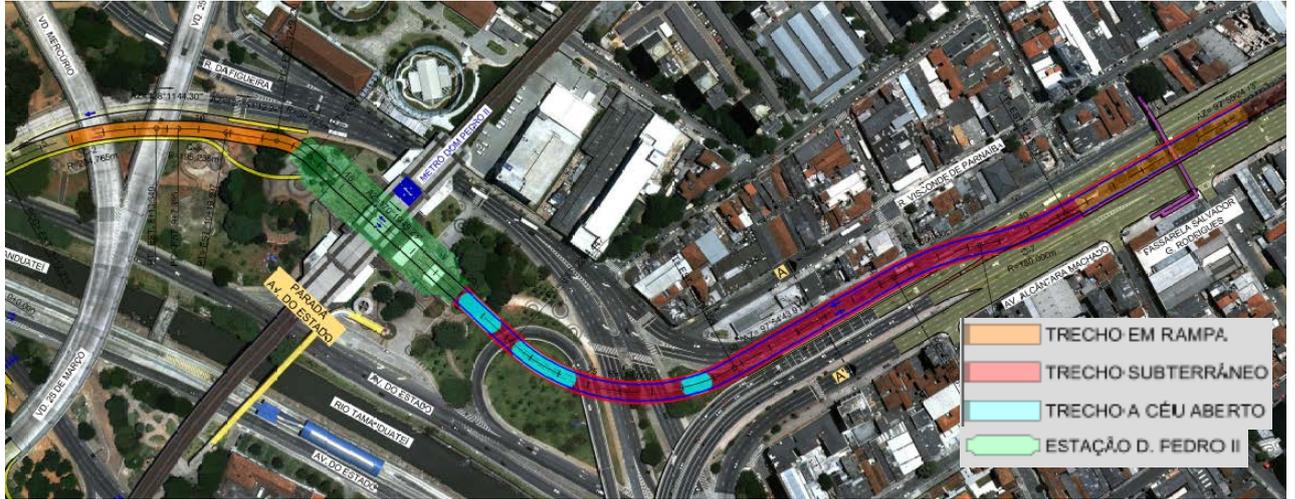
Vista geral dos túneis de interligação com a Passagem Subterrânea Estado.
